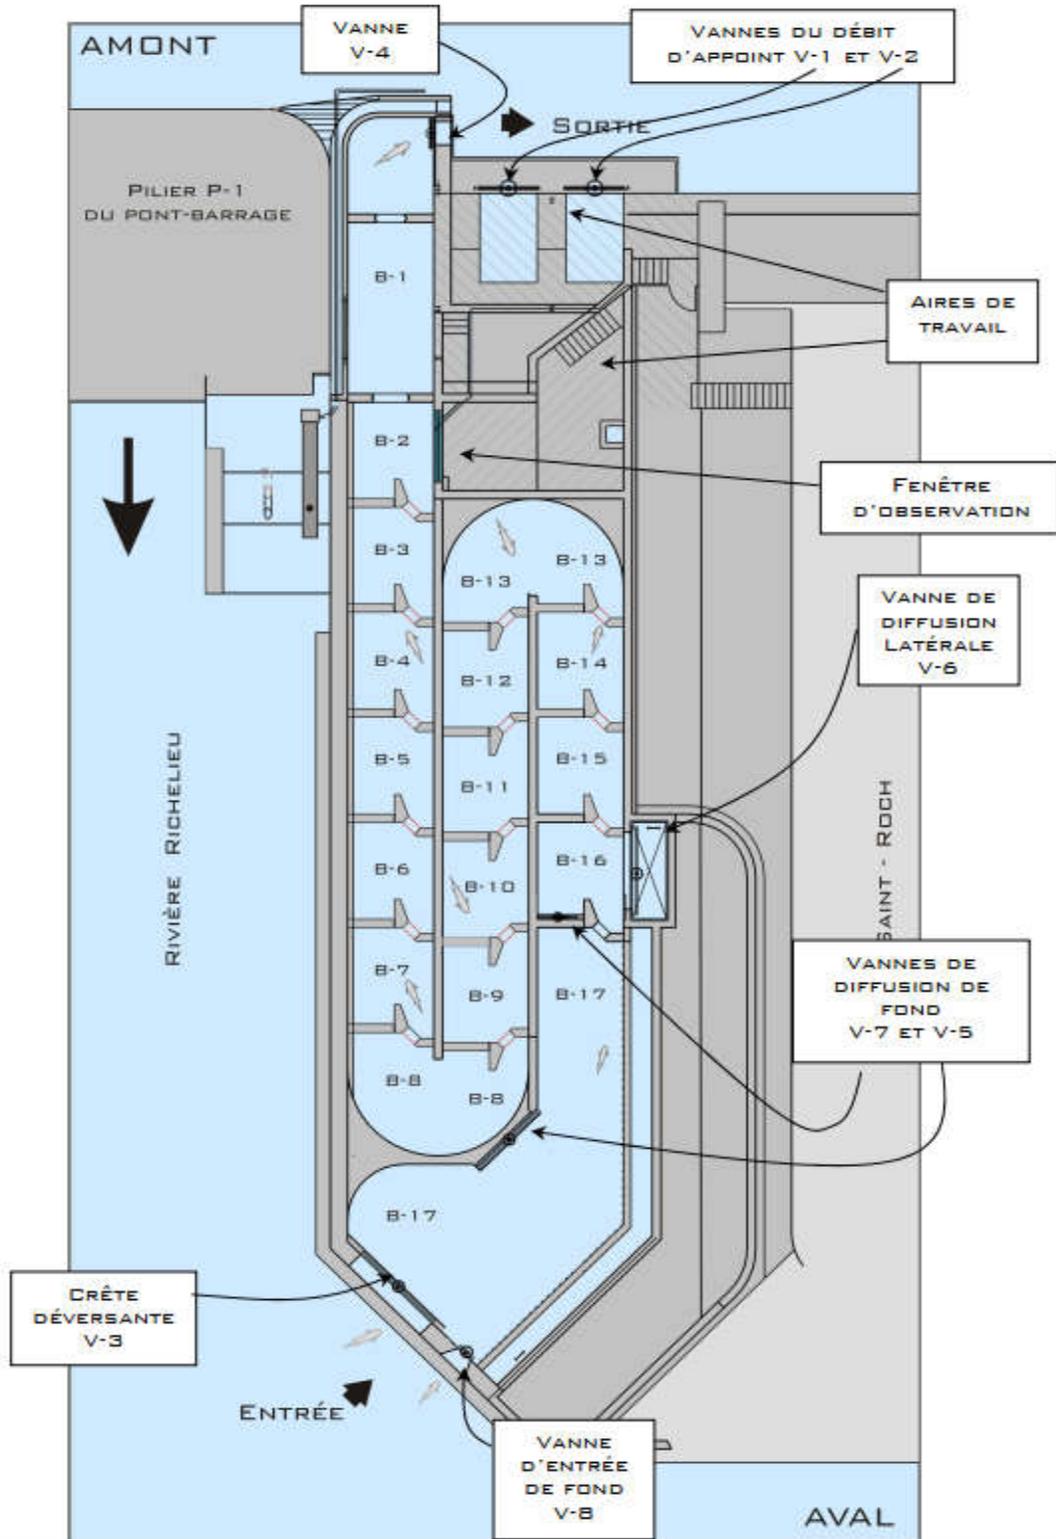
plan général de la passe migratoire Vianney-Legendre
